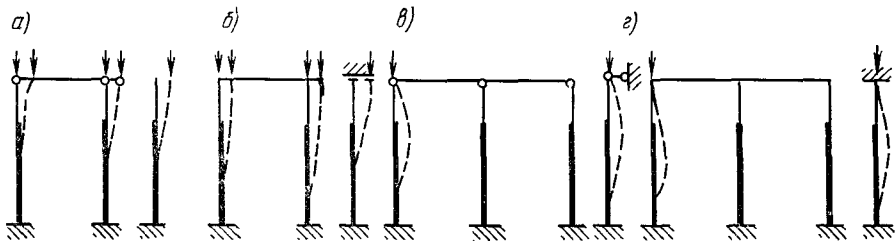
Расчетные схемы опирания ригелей на колонны
